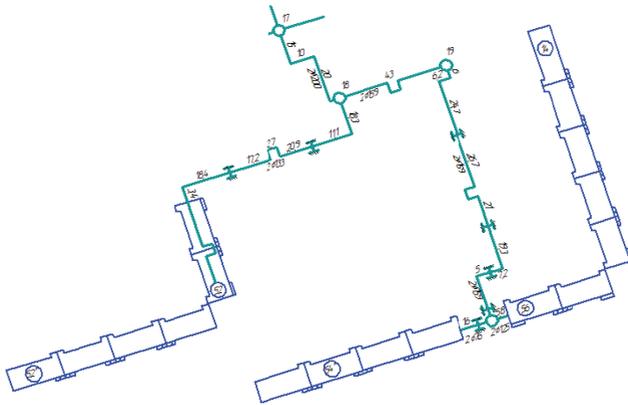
Фрагмент схемы теплоснабжения группы зданий.
